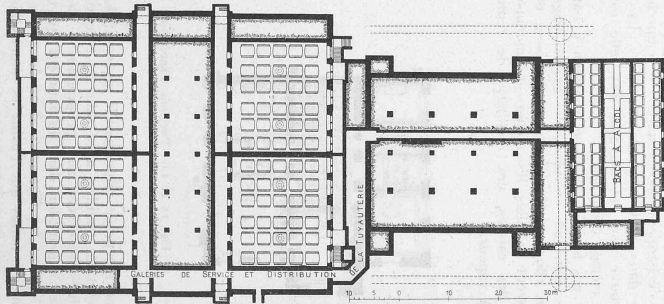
Plan du sous-sol. — Echelle 1 : 1000.
